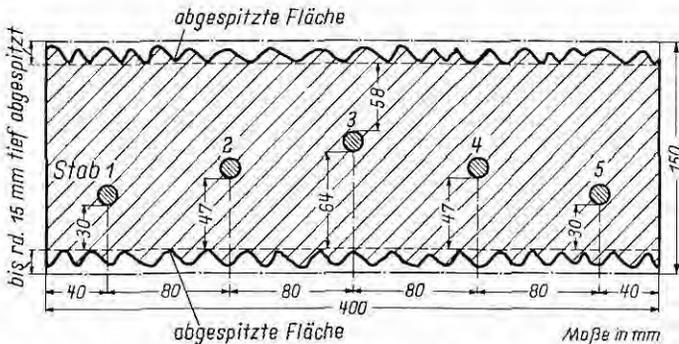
Querschnitt der abgespitzten Betonplatten 70 · 40 · 15 cm und mittlere kleinste Überdeckung der 5 Bewehrungsstäbe
